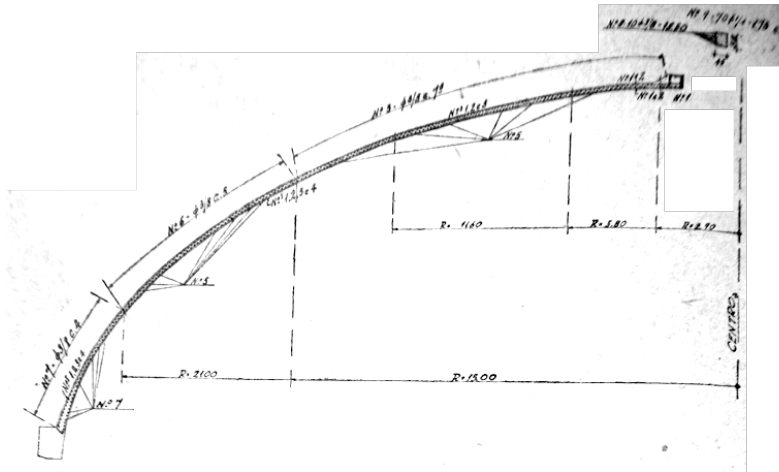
Corte da cúpula mostrando a armadura. Esta é dupla e as emendas foram feitas alternadamente
